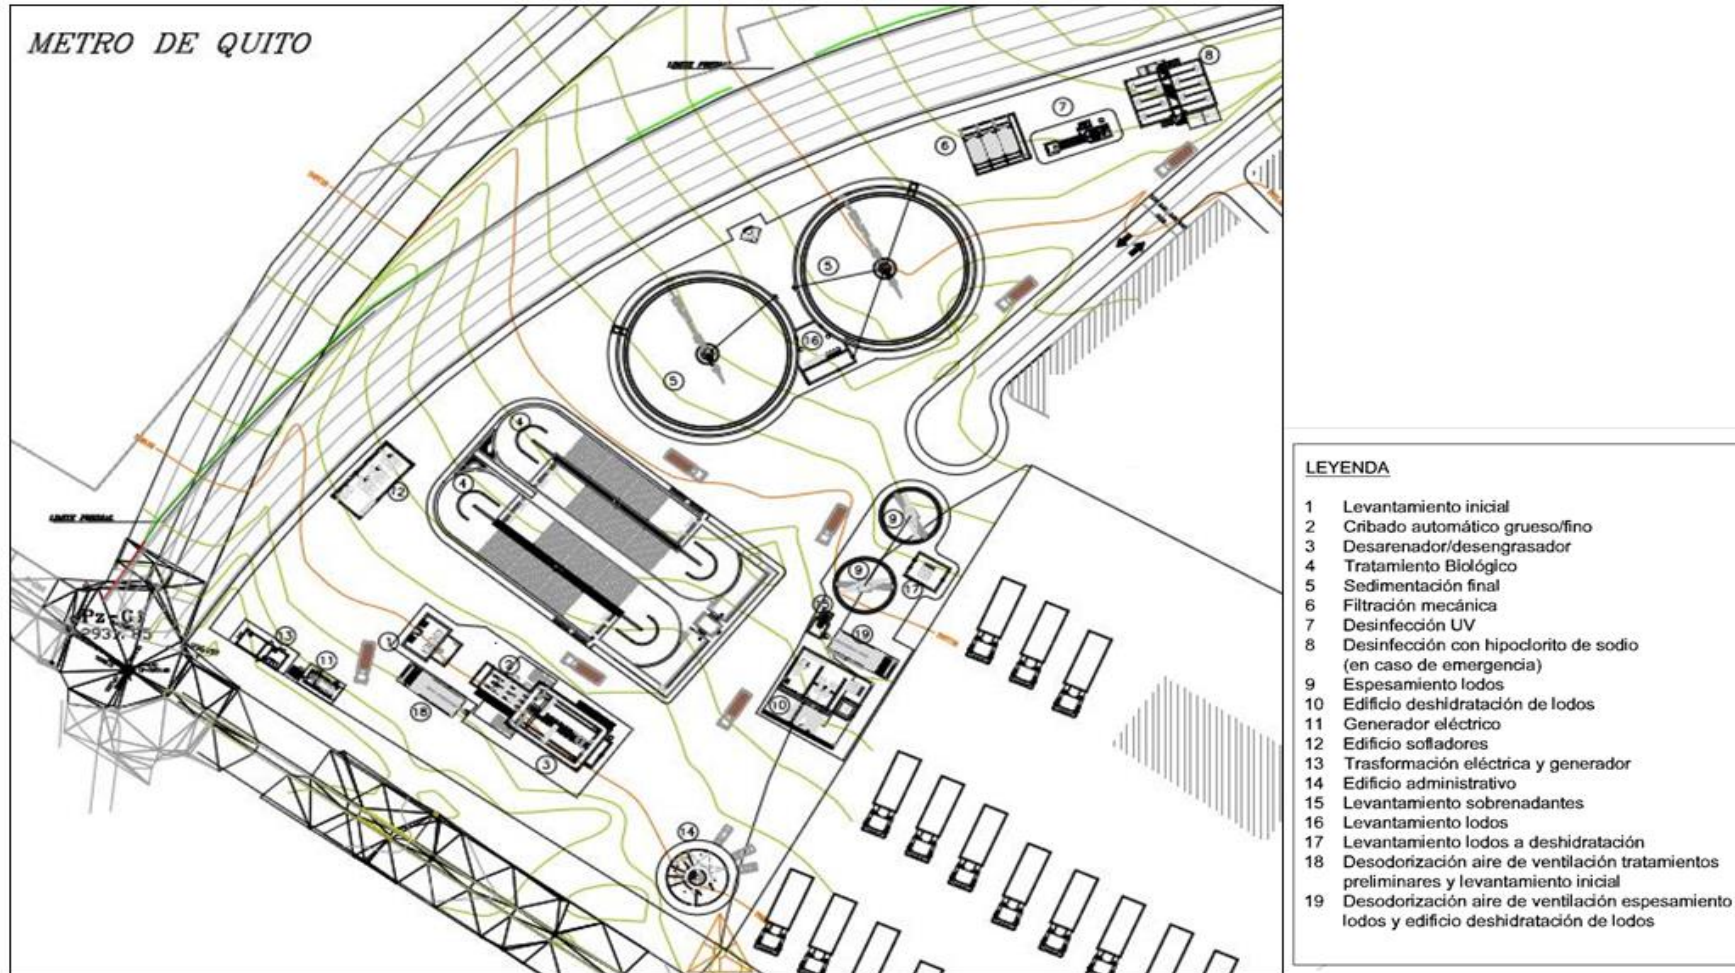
Planimetría de las secciones de tratamiento de la planta de Quitumbe
